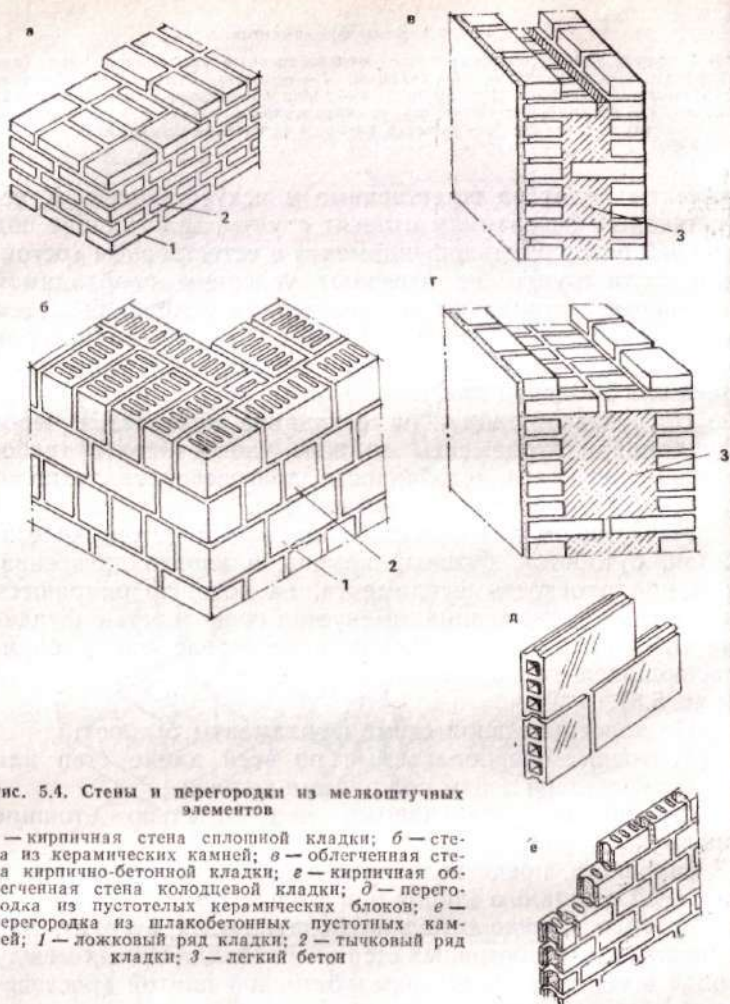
Стены и перегородки из мелкоштучных элементов
